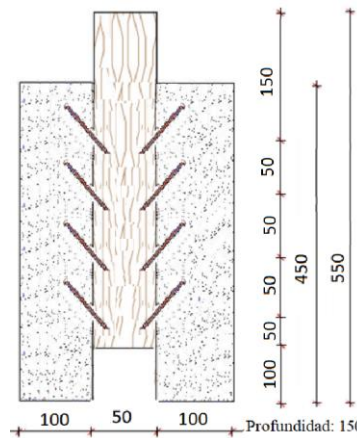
Espécimen de Hormigón-Madera-Hormigón (HMH)
